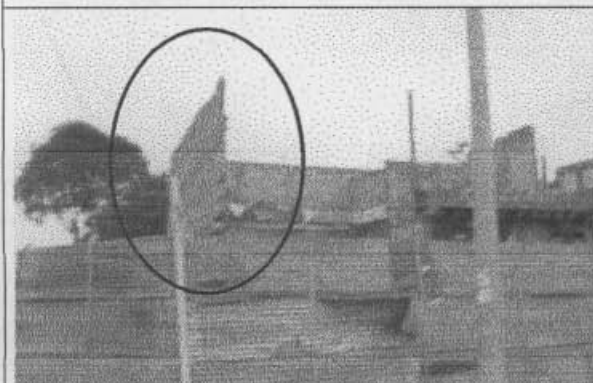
Se identificó alta vulnerabilidad riesgo de colapso del muro ubicado por el costado sur de la construcción a nivel de segundo piso.
